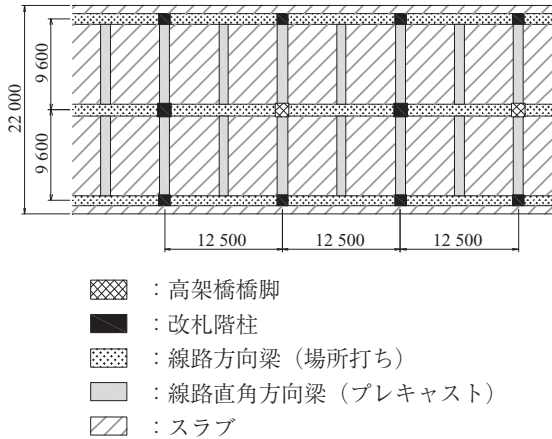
改札階平面図 (図 - 3 の 1-1 断面)
